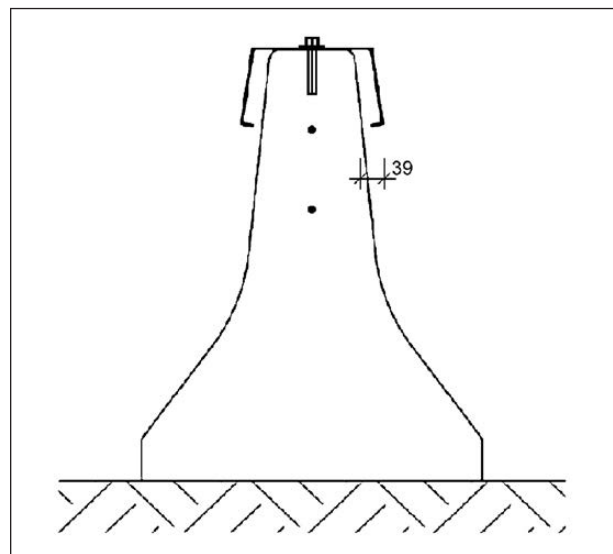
BSW O im New-Jersey-Profil mit 2 Ø 12 mm Bewehrung frei auf Asphalt aufgestellt; Quelle: DEKRA
